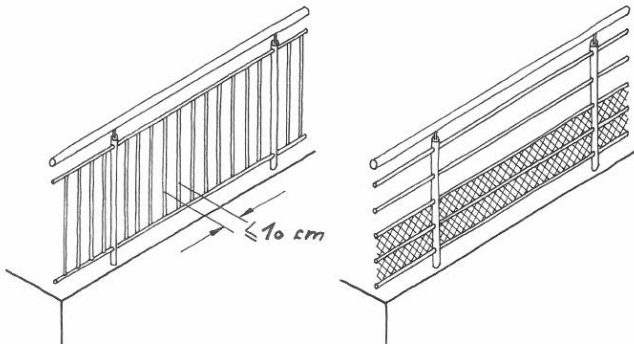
Géométrie des garde-corps (entraxe entre barreau verticaux et dispositif empêchant d'y grimper)
